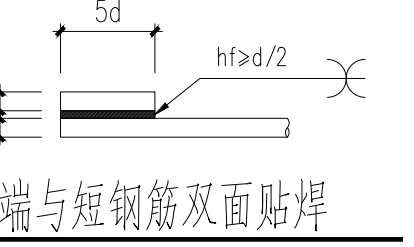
钢筋末端与短钢筋双面贴焊
